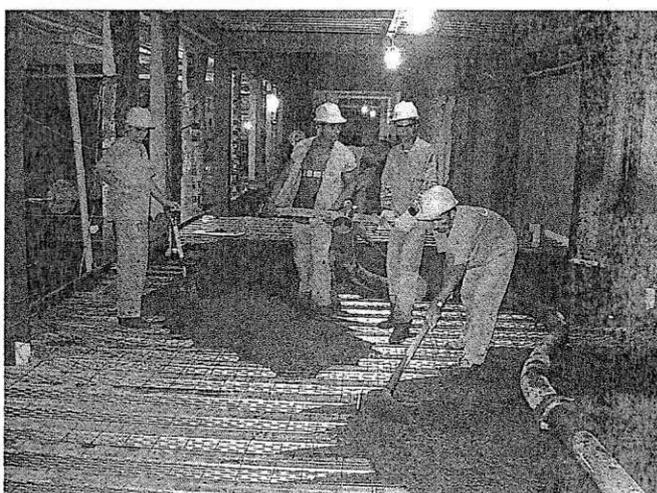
Concretagem das Lajes *Steel Deck*, observar a colocação da tela.
